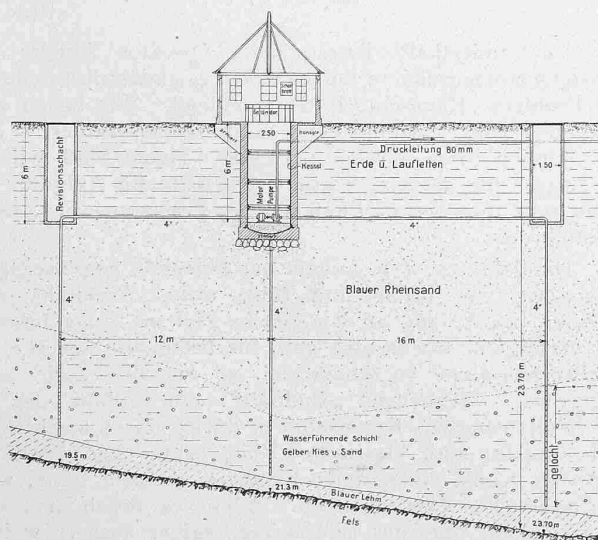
(link-) Schnitt. — Masstab 1 : 400. — Abb. 2. Grundriss.
